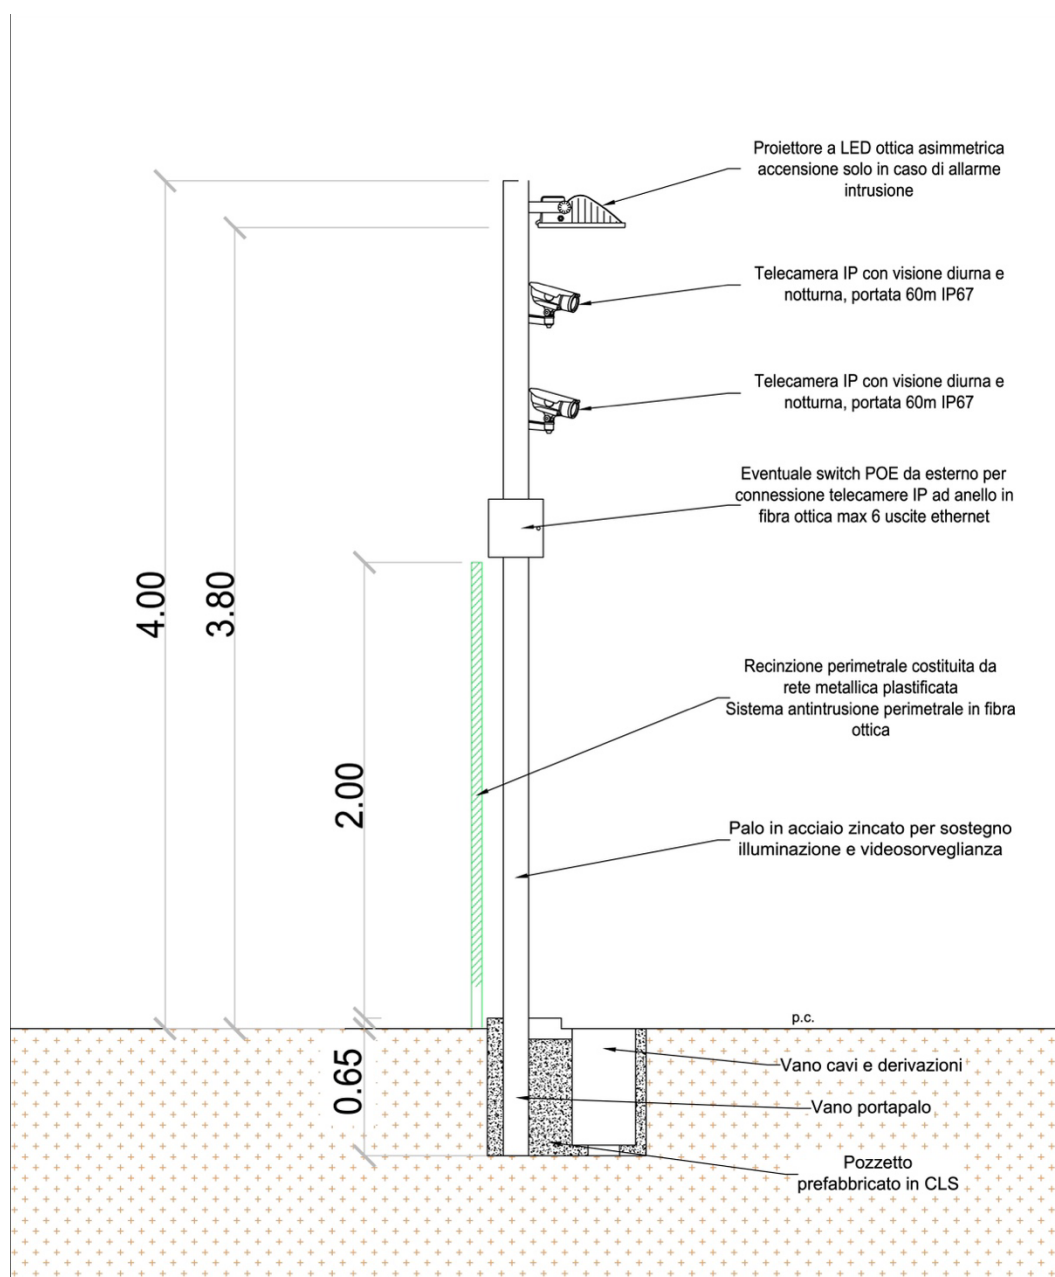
Tipologico palo per illuminazione e videosorveglianza con fondazione a pozzetto
